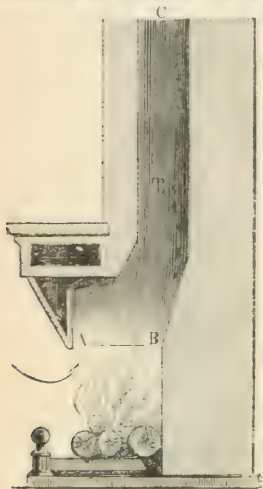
Coupe d'une cheminée dont la profondeur est indiquée en AB. — C, conduit.
